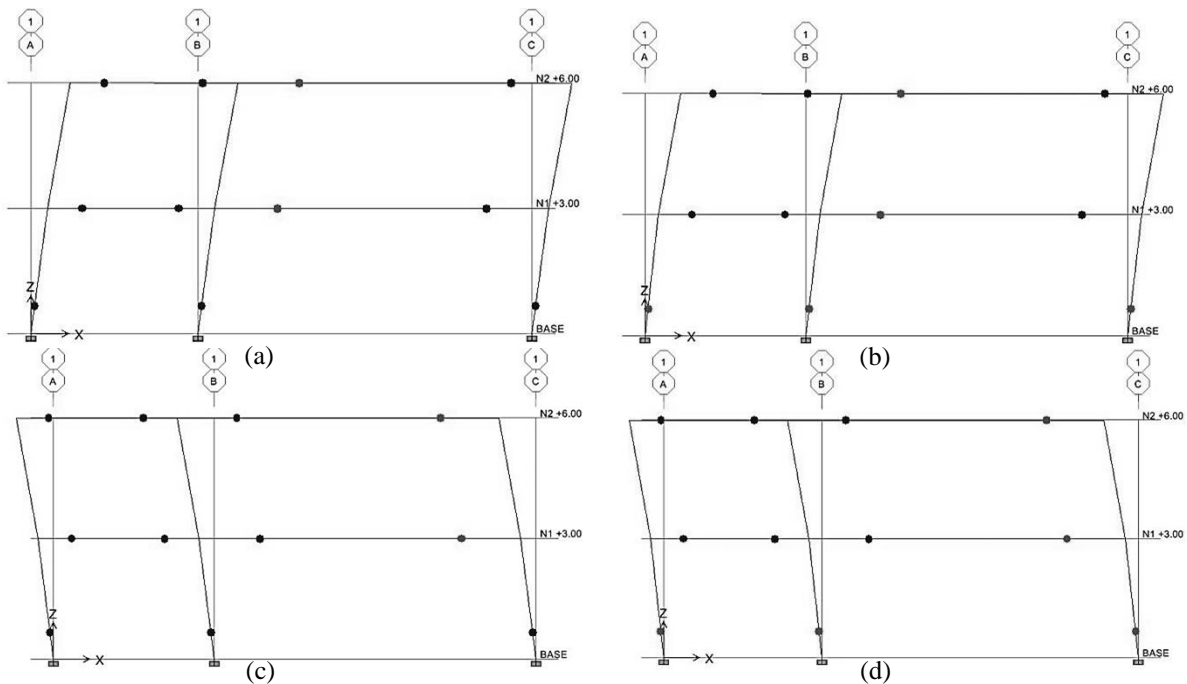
Mecanismo plástico de colapso para el Pórtico 2.3:
